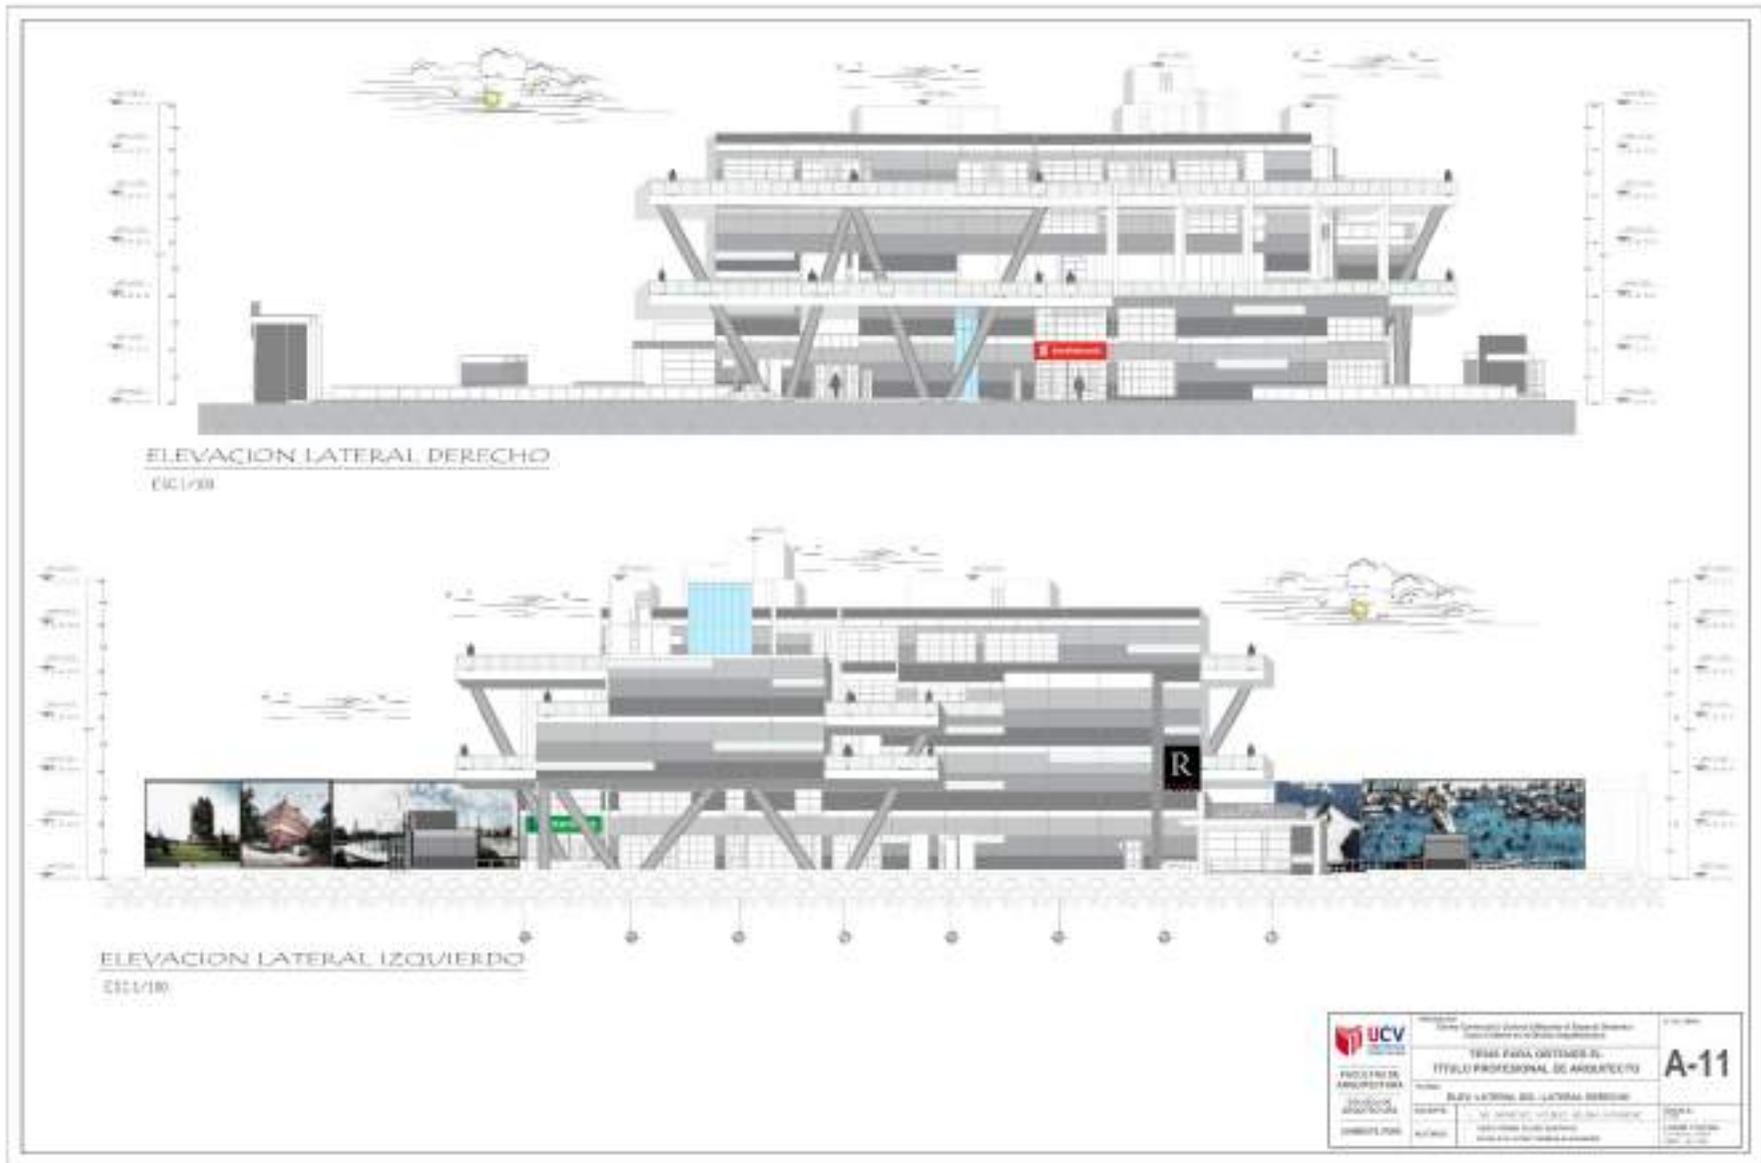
Plano Elevación Lateral Derecho e Izquierdo
